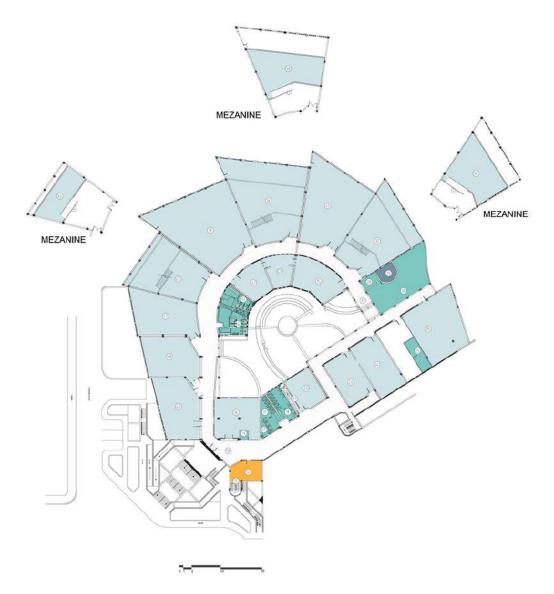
Planta 1 Bloque 44. Fuente: Equipo de diagnóstico.
